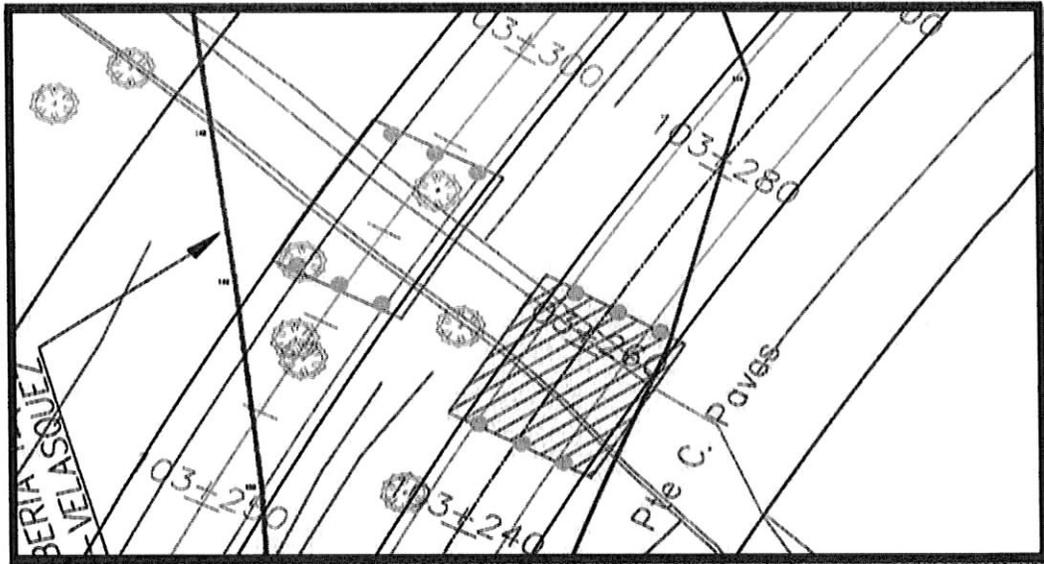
acercamientos críticos con estructuras viales (Puentes) e Infraestructura petrolera
